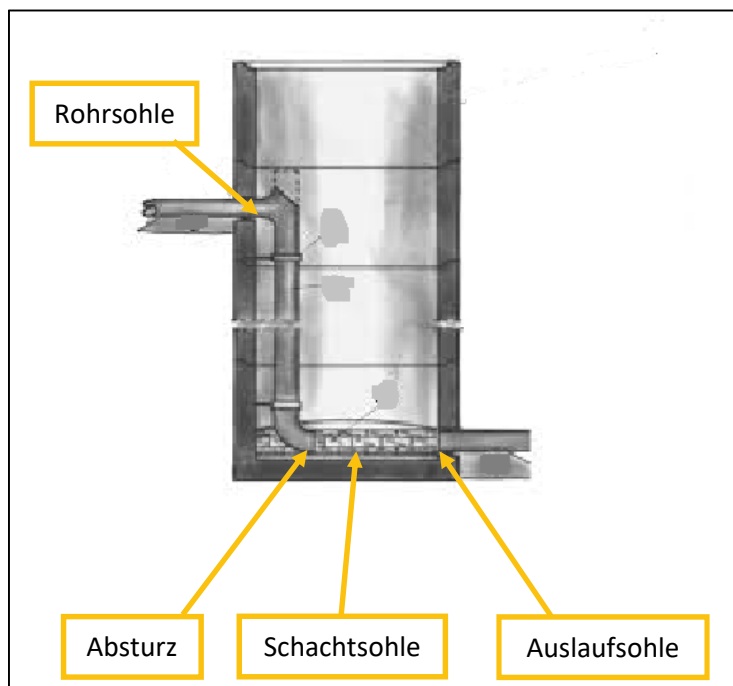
Prinzipskizze Schachtaufbau rund Absturzbauwerk mit innenliegendem Untersturz
